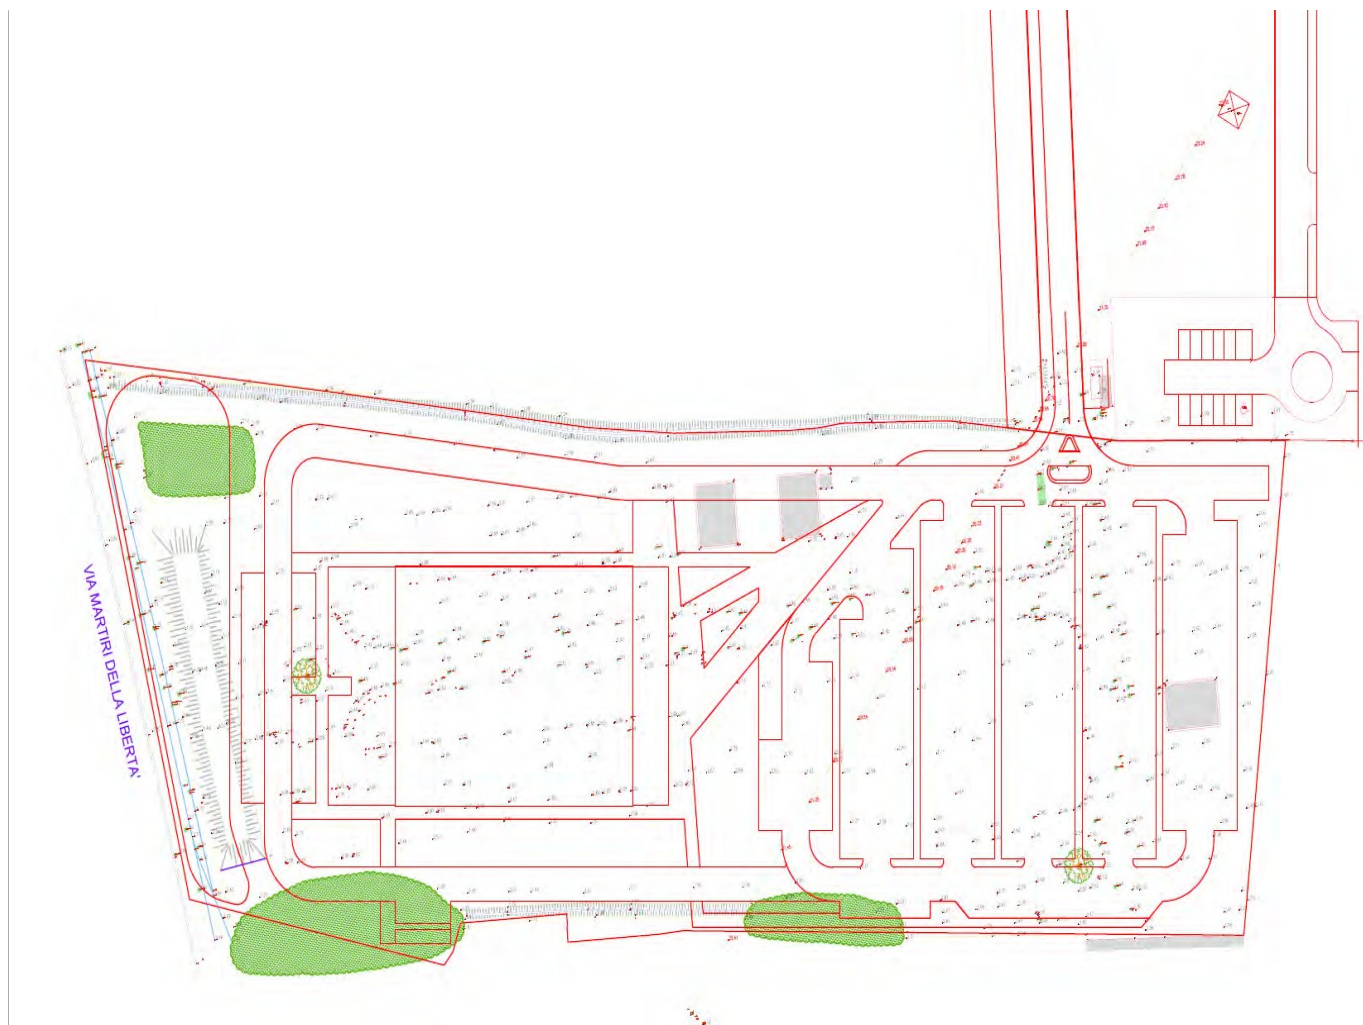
ESTRATTO PLANIMETRIA CON SOVRAPPOSIZIONE SDF-SDP
